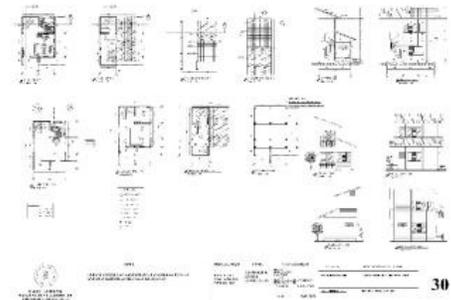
Denah, rencana atap, utilitas dan listrik
